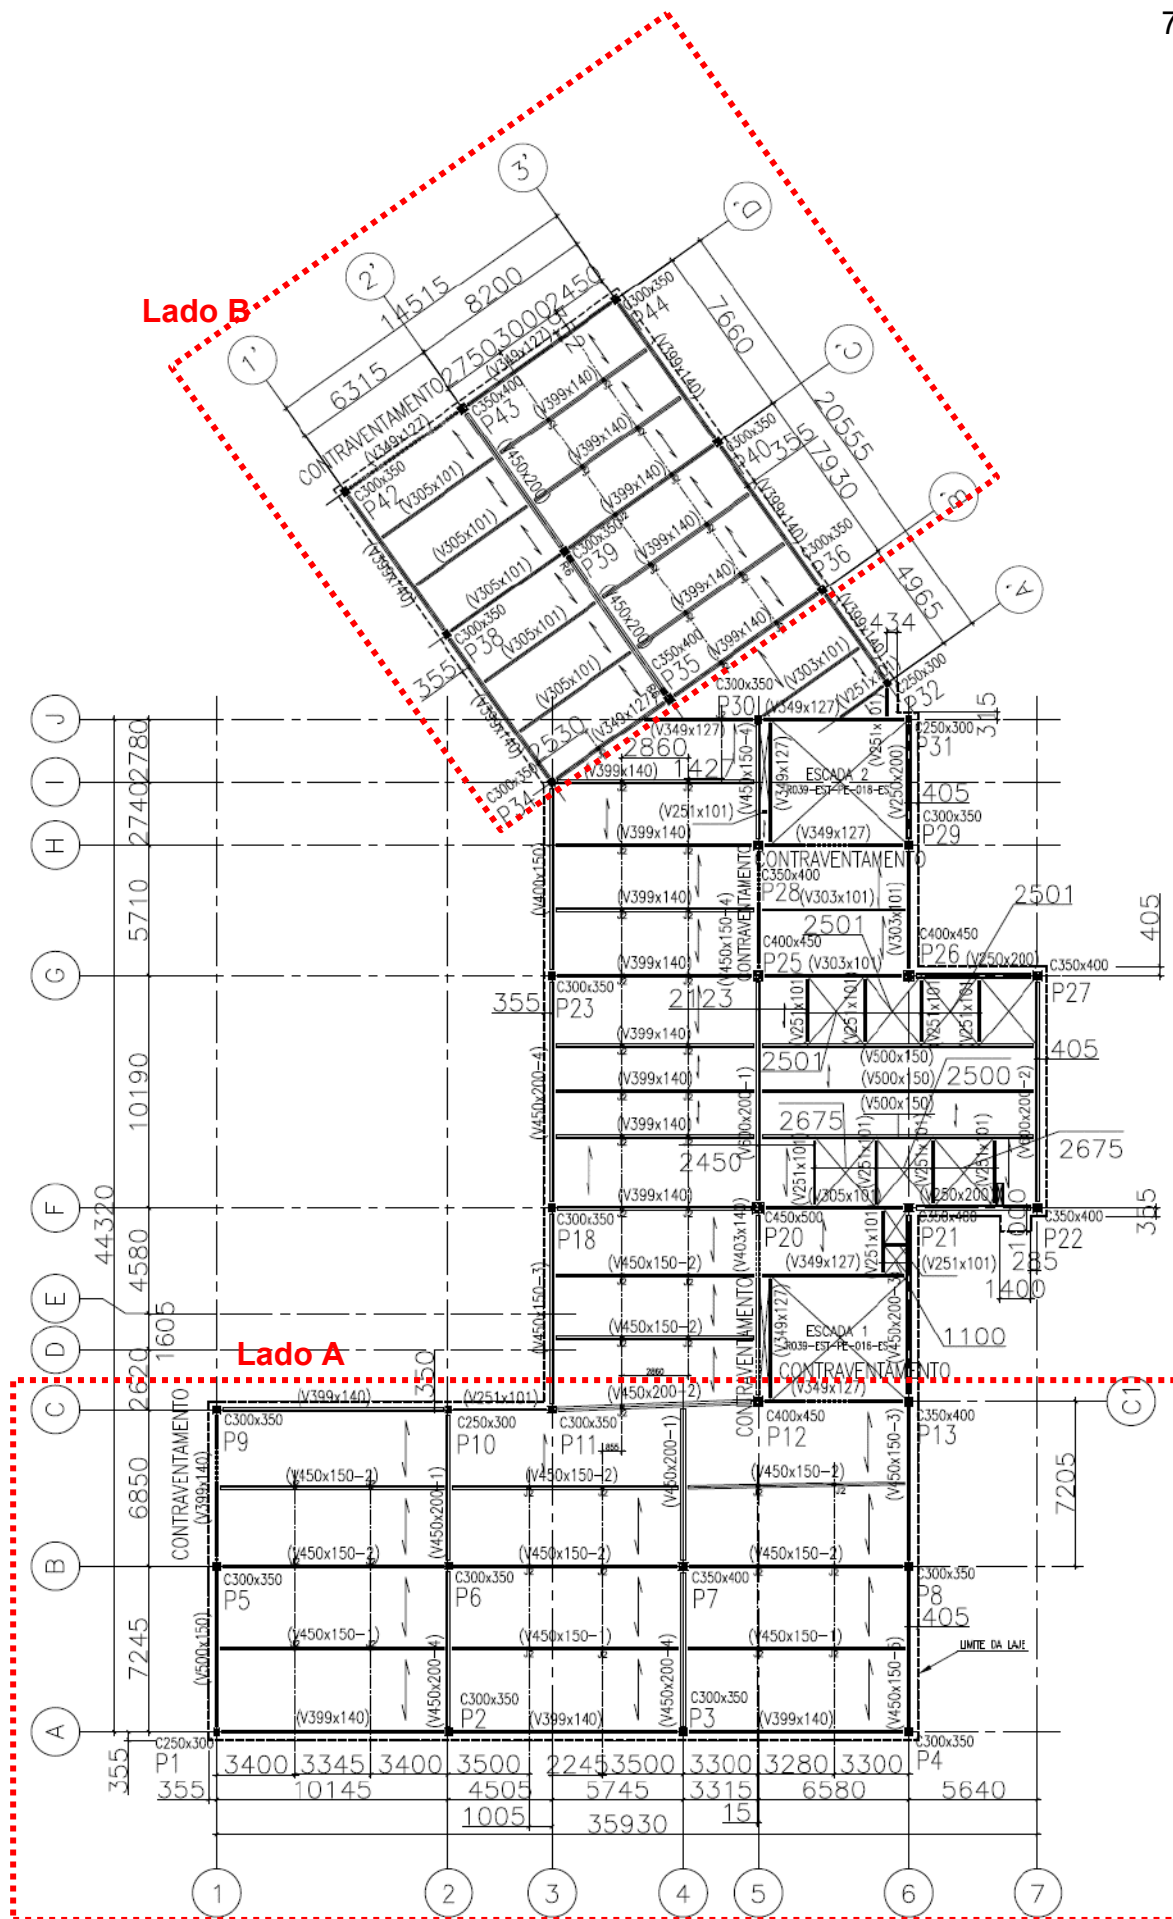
Piso misto (aço-concreto) investigado: 8º pavimento (cotas em mm).
